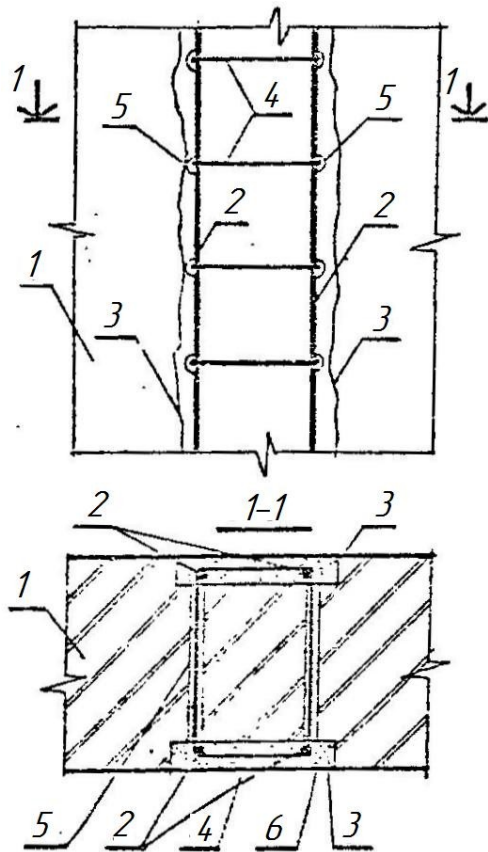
Встановлення арматури із двох боків стіни у утробах: 1 – посилювана стіна; 2 – поздовжня арматура посилення; 3 – утроба, пробита в стіні; 4 – поперечні хомути, пропущені в просвердлені в стіні отвори; 5 – отвори в стіні; 6 – штукатурка із цементно-піщаного розчину
